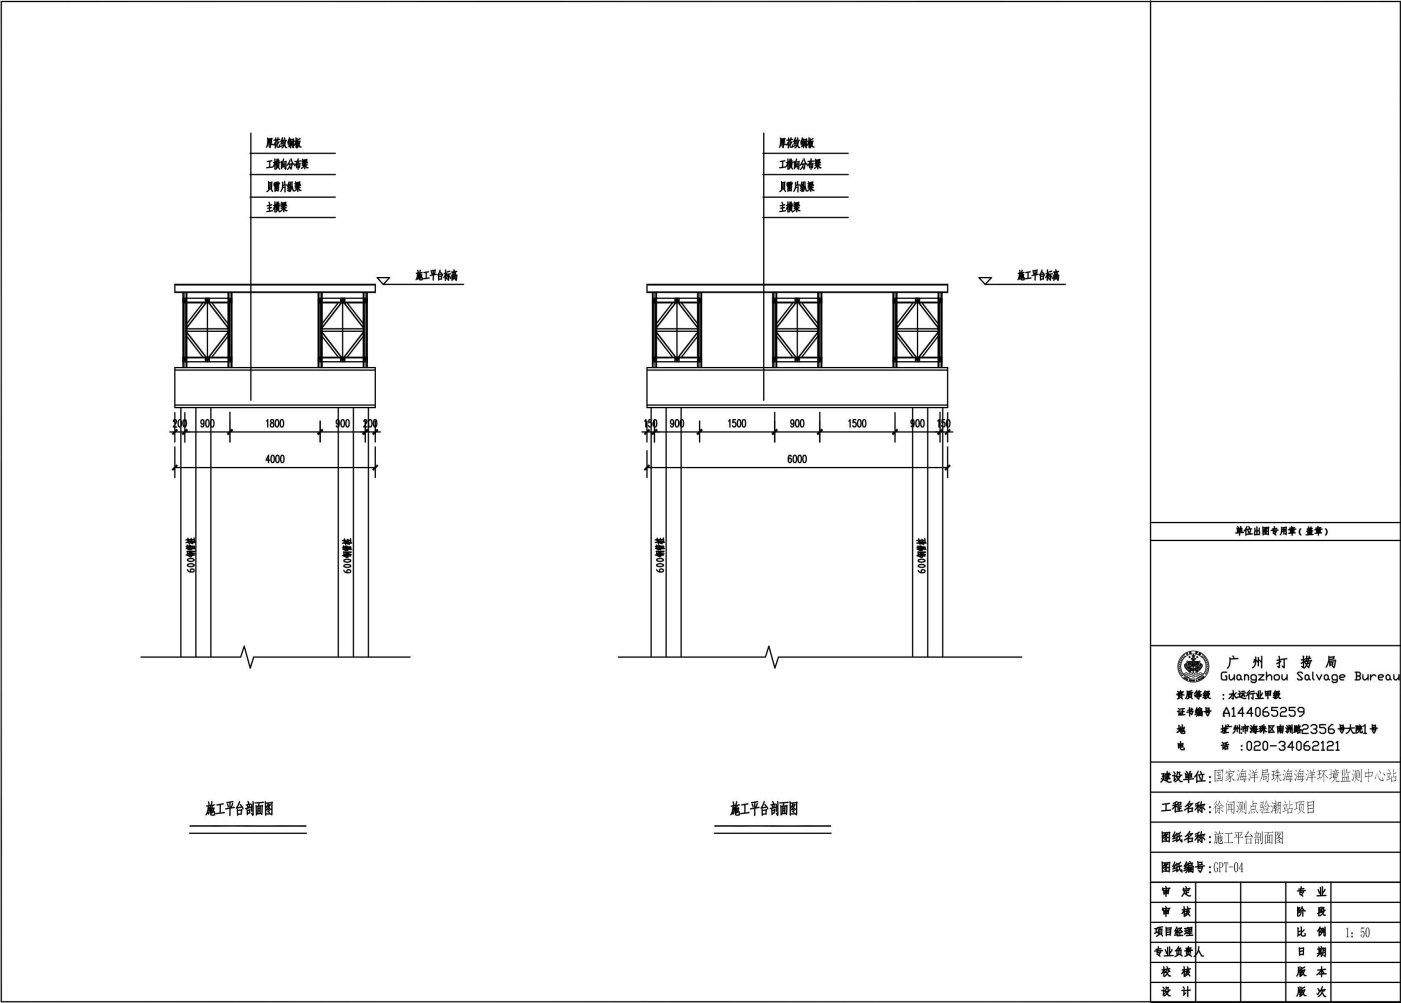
施工平台B-B（左侧）和C-C（右侧）剖面图
